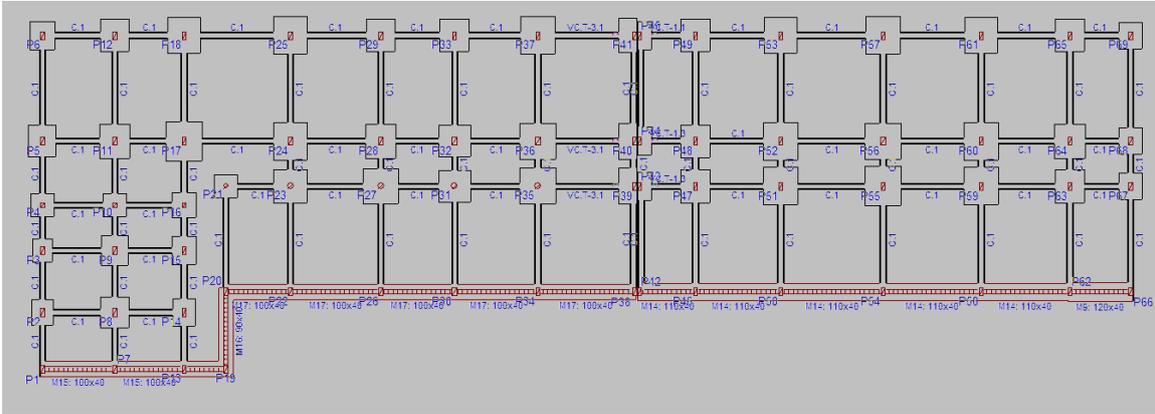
Cimentación Superficial por Zapatas aisladas de la Zona A del edificio docente
